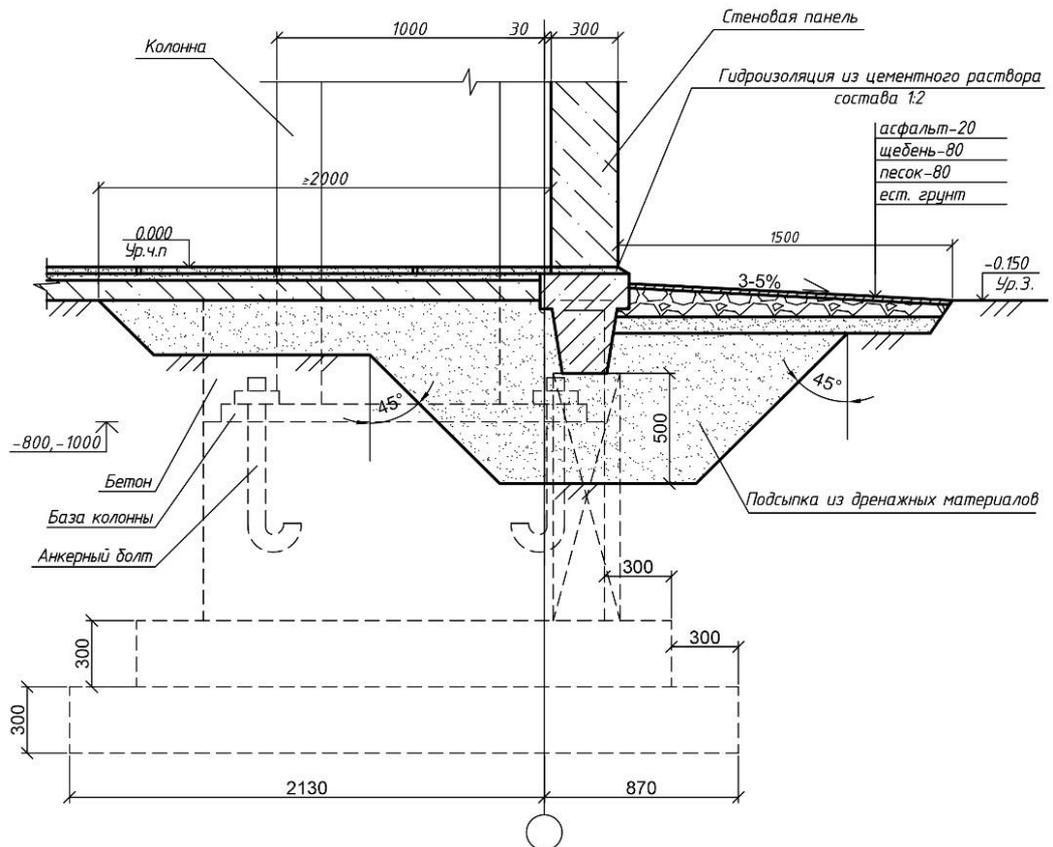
Узел фундамента под стальную колонну крайнего ряда
